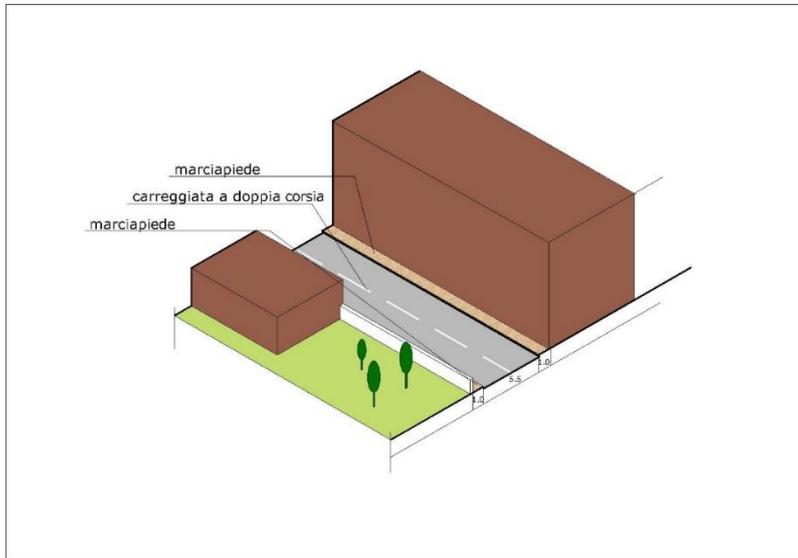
Rappresentazione schematica stato di fatto sezione 2
